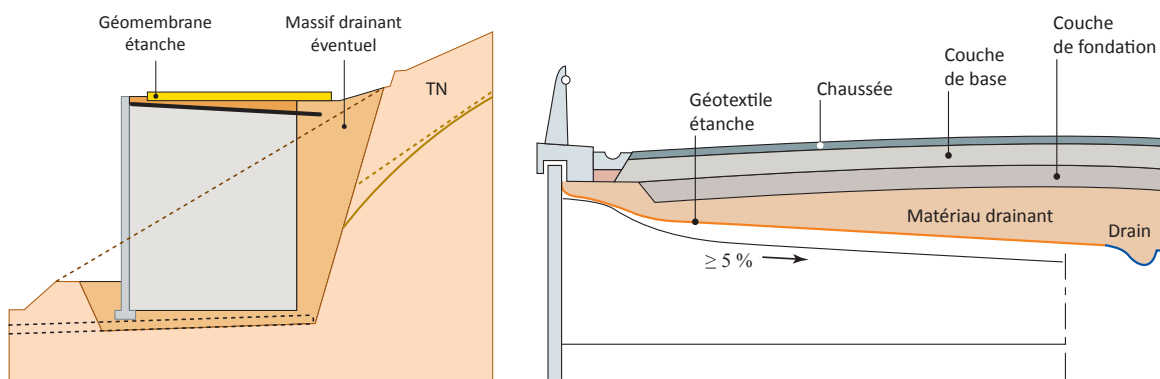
Exemple de dispositifs de drainage et d'assainissement d'un mur (source (1))
